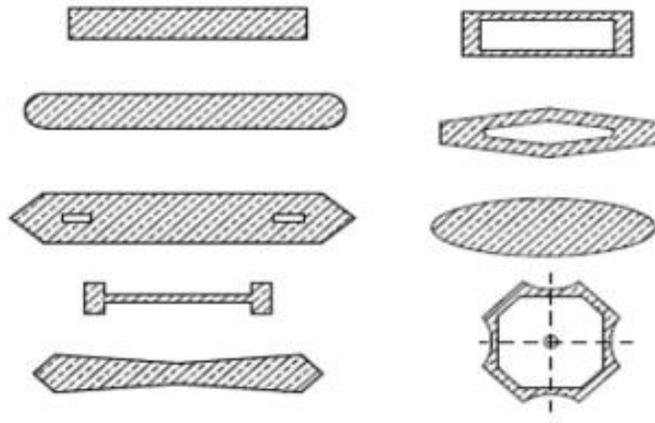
Formas de secciones transversales de pilares-pared
